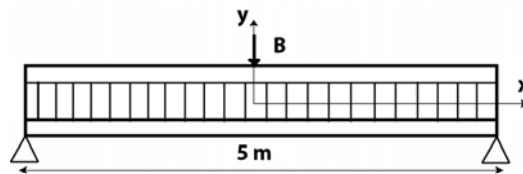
Flexion trois points d'une poutre en béton armé
